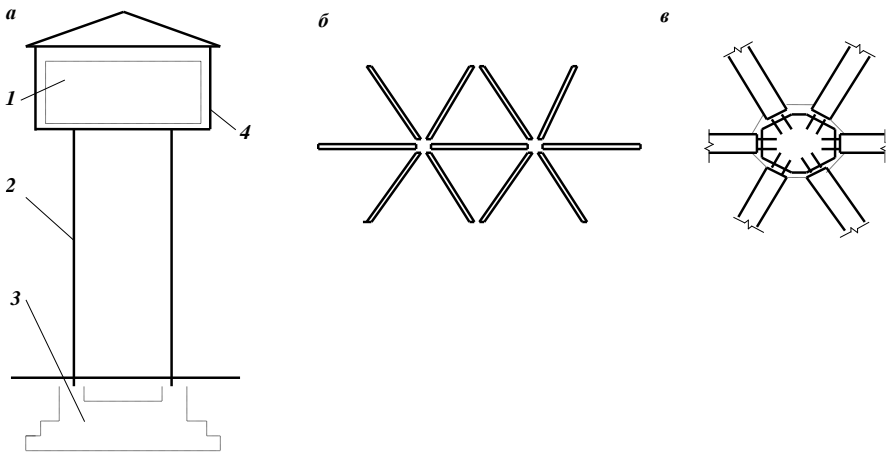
Конструкція водонапірних веж (а), компонування сітчастих опор (б) та вузол з'єднання елементів (в)
